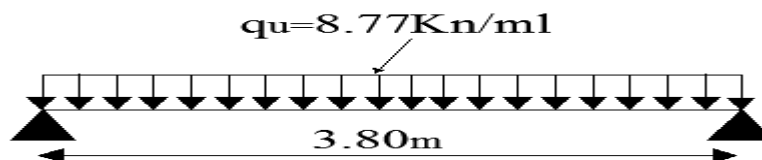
Schéma statique de la poutre de chaînage à l'ELU.
